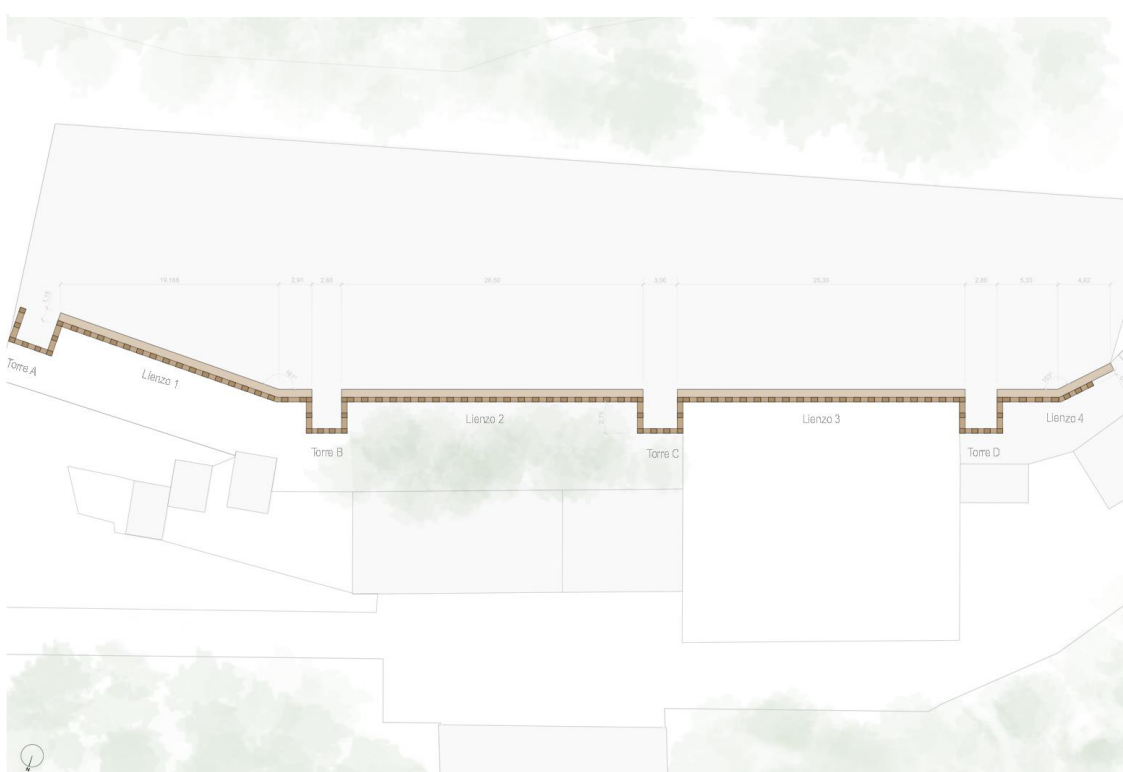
Planta del Tramo Norte. Escala 1/700. Fuente: Autora.
